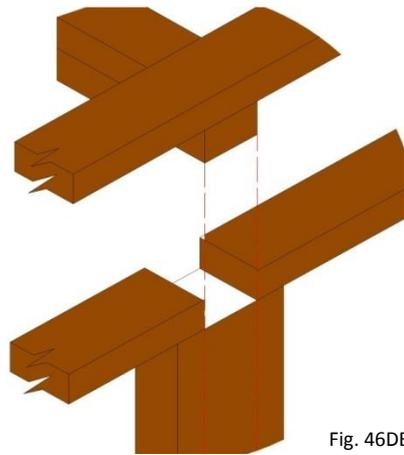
DETALLE ENSAMBLE SOLERA INFERIOR
